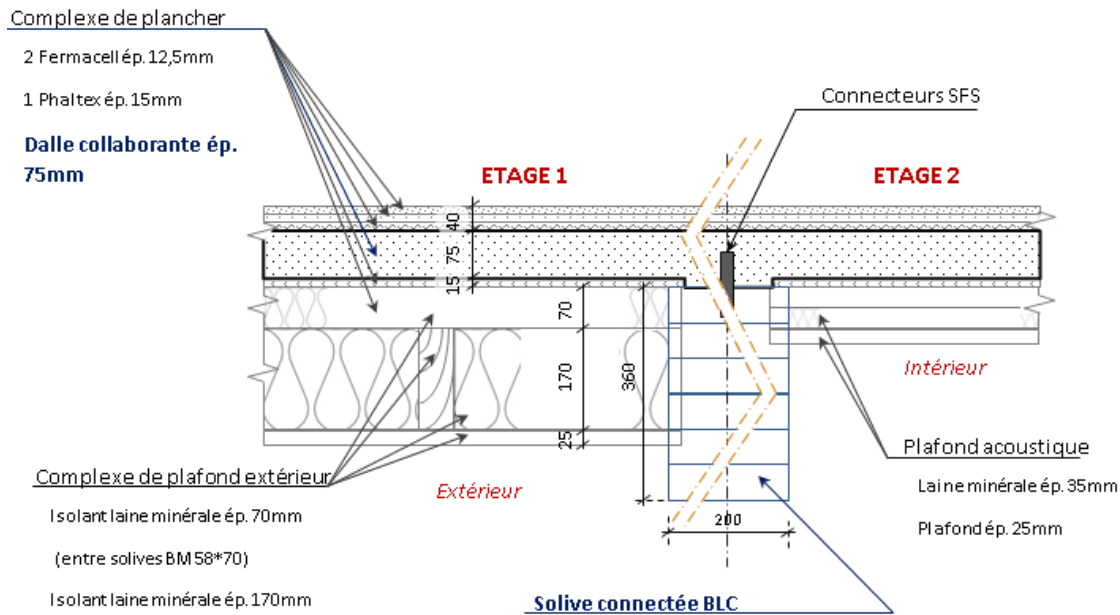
Vue en coupe du plancher mixte de l'extension de l'ESB (selon les plans d'Arborescence S.A.R.L.)
